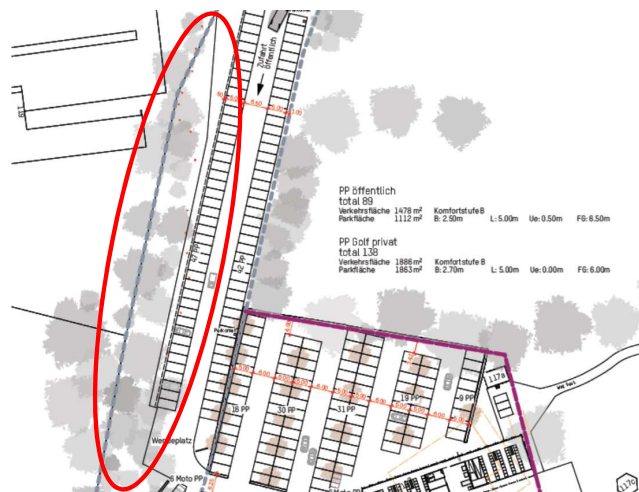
Golfanlage Interlaken-Unterseen (massstabslos) mit Bauvorhaben (rote Kreise)
